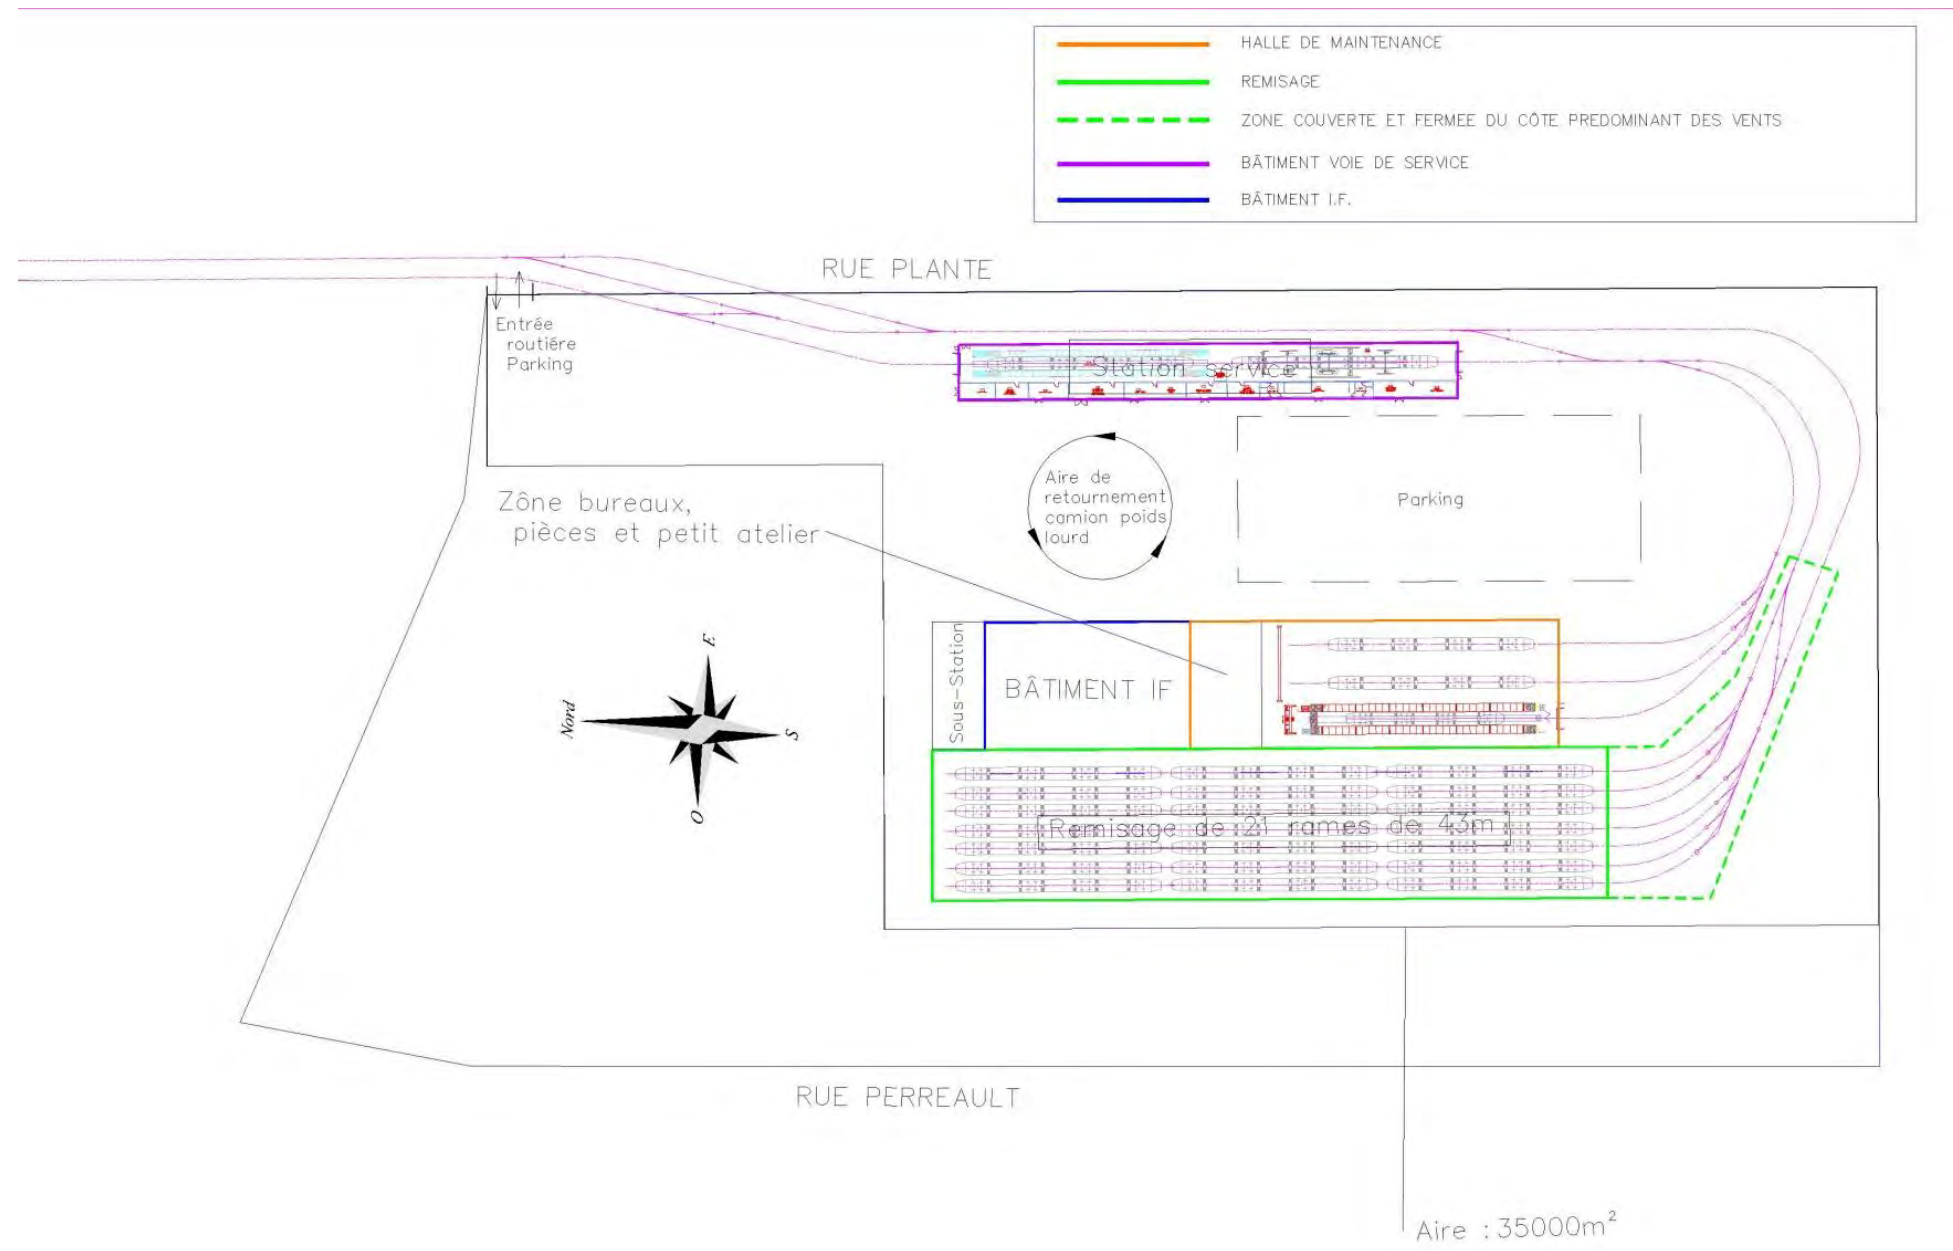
Plan masse CEE Secondaire – rue Plante, Lévis
